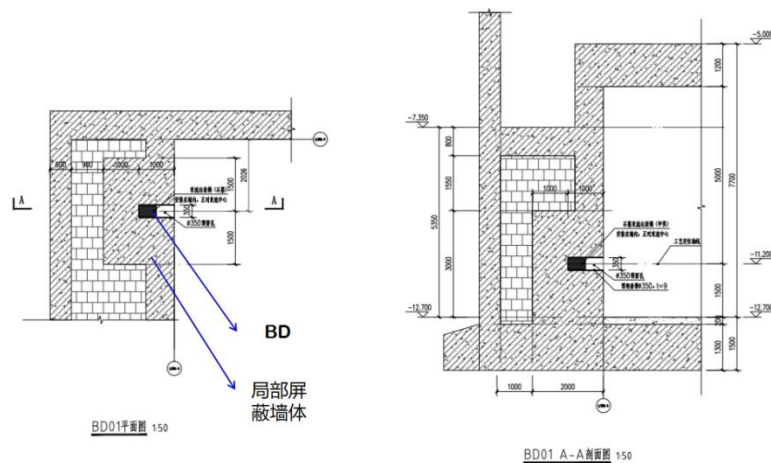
低能综合终端 BD 及局部屏蔽混凝土墙体结构建造图
